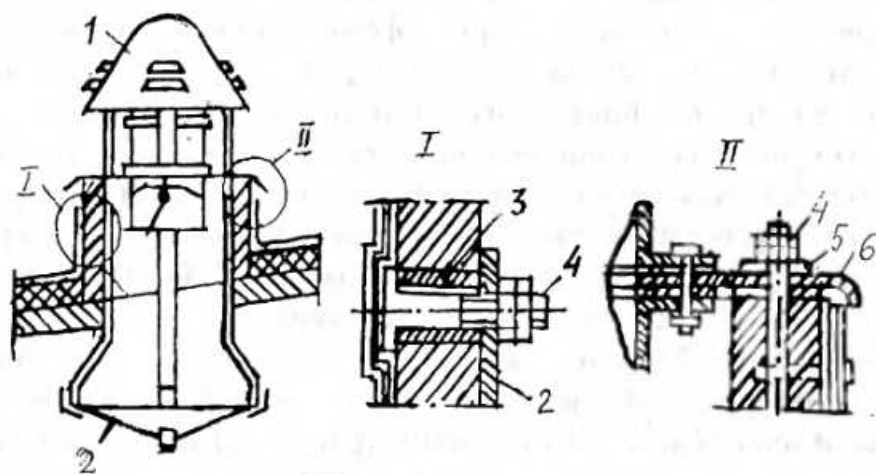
Встановлення дахового вентилятора на залізобетонному стакані: 1 - вентилятор, 2 - піддон, 3 - закладна трубка, 4 - болт, 5 - прокладка, 6 - дашок
